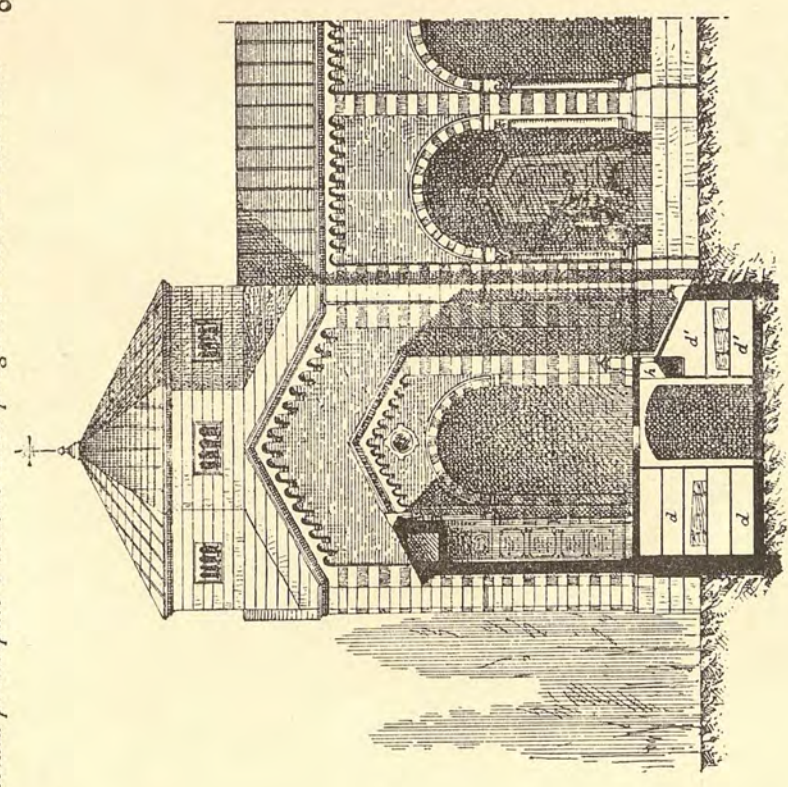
Prospetto della muratura e di un'edicola, secondo il nuovo progetto.
